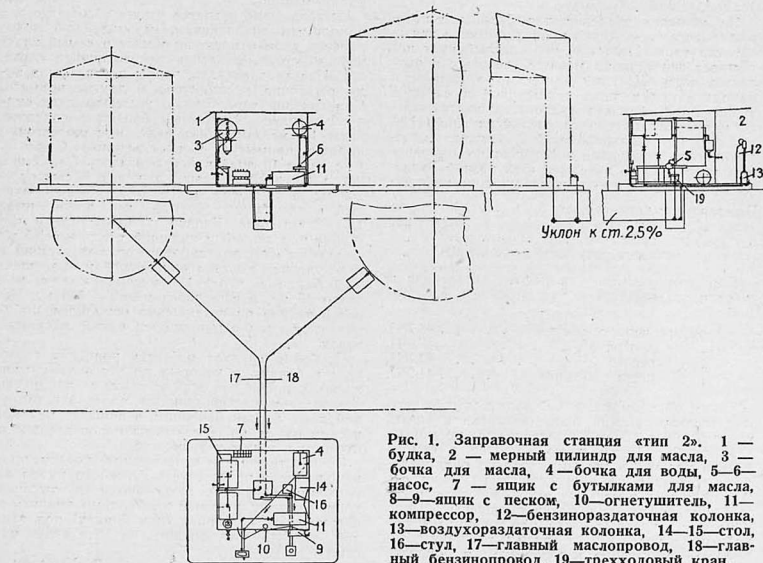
Заправочная станция «тип 2». 1 — будка, 2 — мерный цилиндр для масла, 3 — бочка для масла, 4 — бочка для воды, 5 — насос, 7 — ящик с бутылками для масла, 8 — 9 — ящик с песком, 10 — огнетушитель, 11 — компрессор, 12 — бензинораздаточная колонка, 13 — воздухоподдаточная колонка, 14 — 15 — стол, 16 — стул, 17 — главный маслопровод, 18 — главный бензинопровод, 19 — трехходовый кран.
